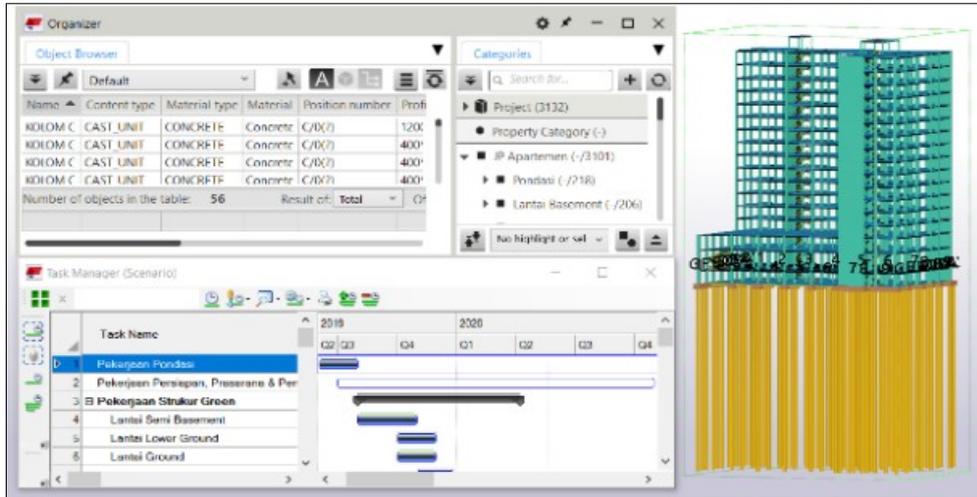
Hasil Pemodelan Keseluruhan Pembangunan *Tower Green Jasmine Park Apartment
